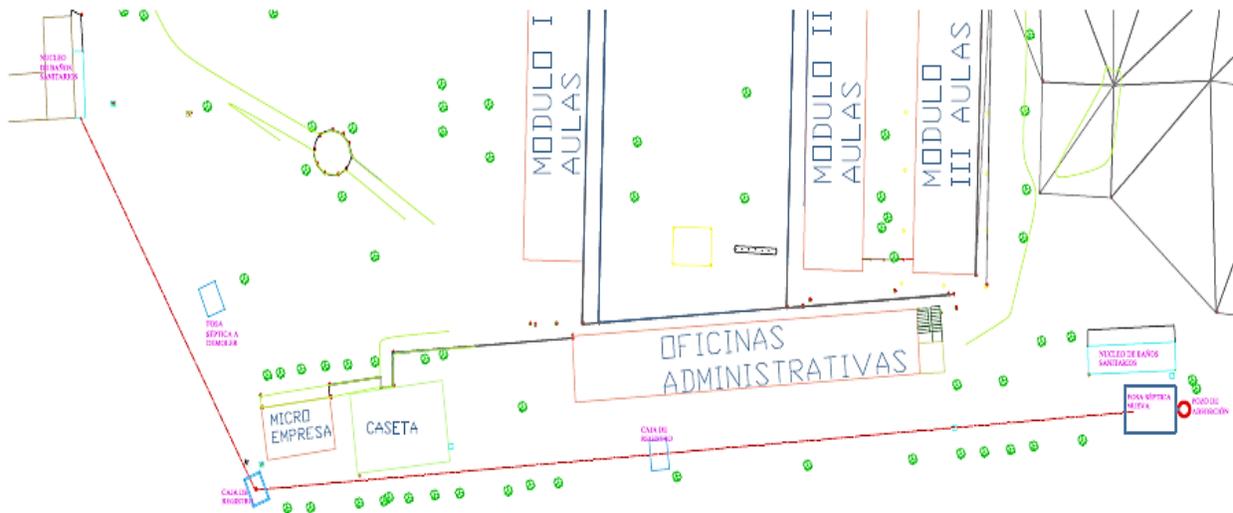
Ubicación de planta de tratamiento en la E.A.V.S
